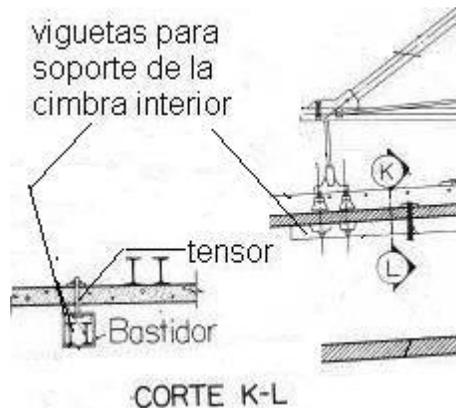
Dispositivo de apoyo de la cimbra interior.
